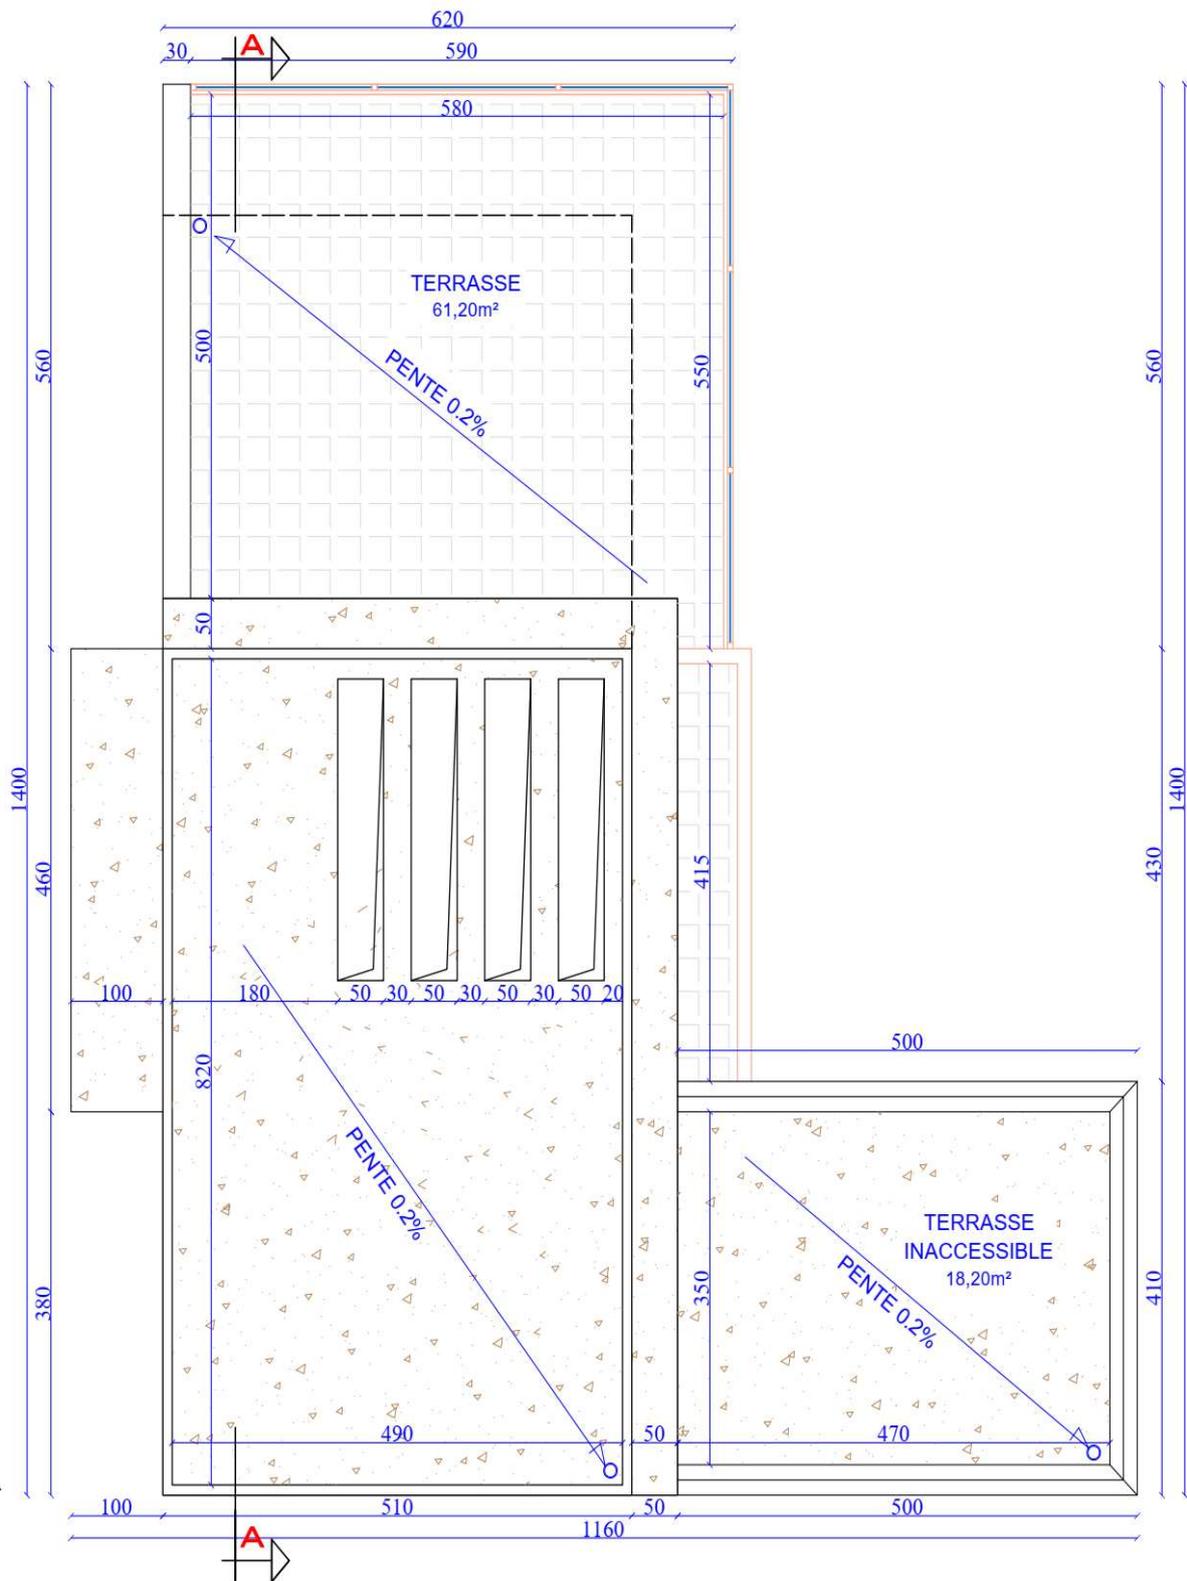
plan de coffrage niveau 0.00 ech 1/50
